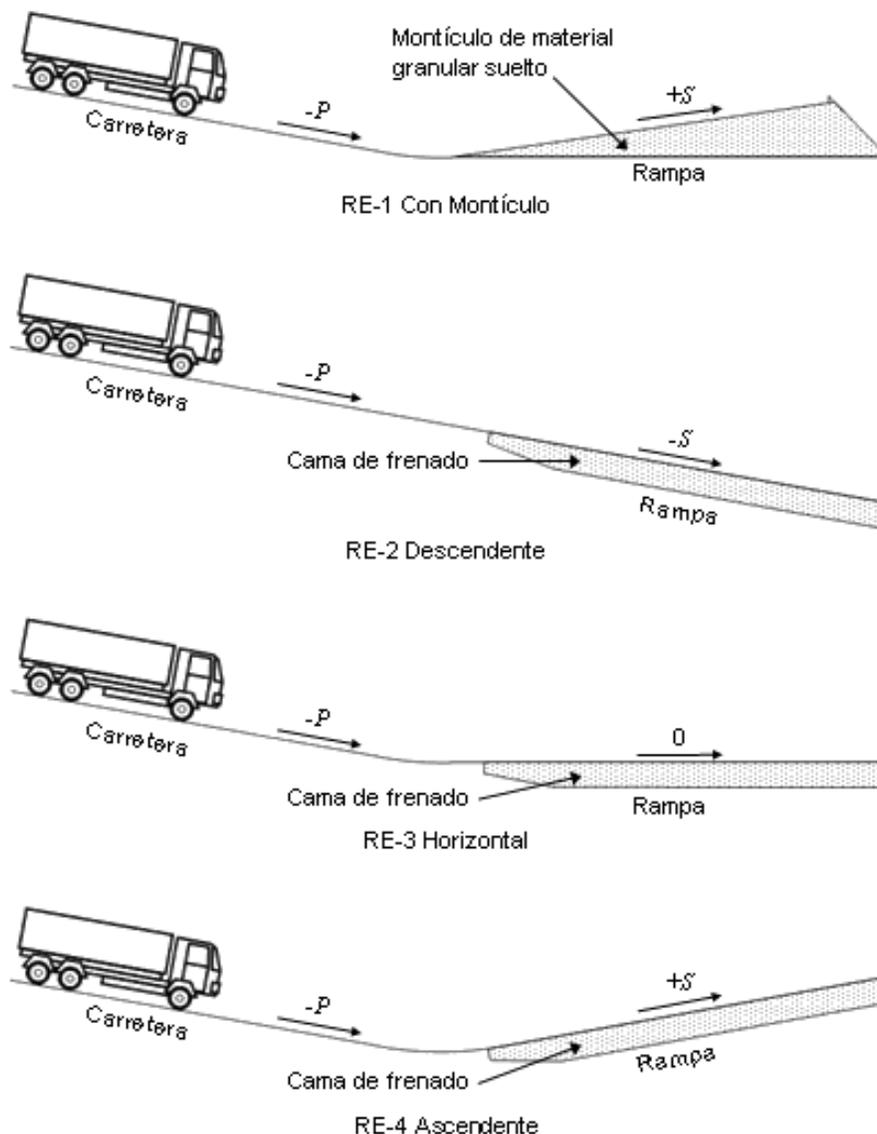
Tipos de rampas de emergencia para frenado (RE)
